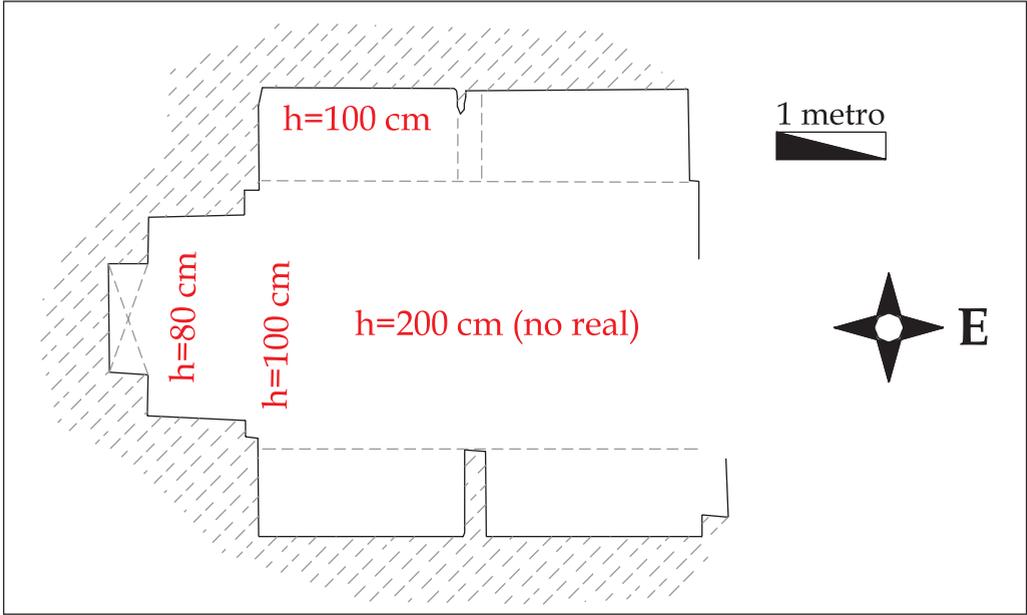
Planta del hipogeo QM C2/27. Tipo 4.2.
